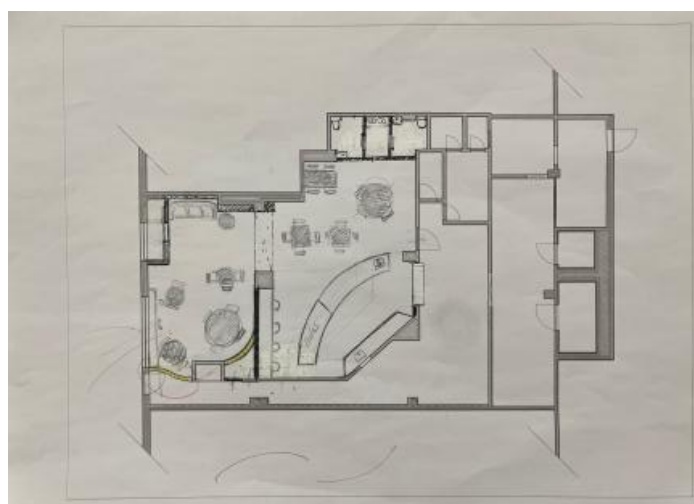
Planta de estudo 1. Fonte: Autora, 2025
